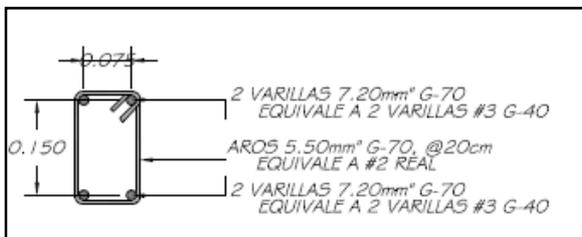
Detalle de la armadura de viga tapichel. Fuente: Manual para la construcción de edificaciones mediante el uso del sistema Modublock.
